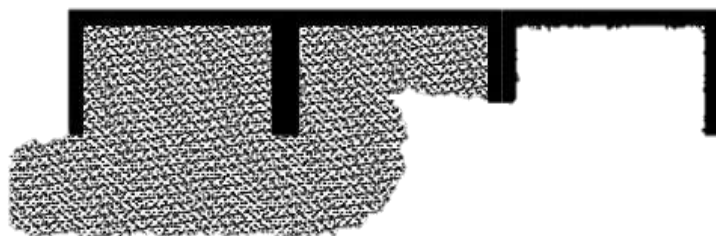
Panneau pour Revêtement des accès aux plages type -GC 85- ou GC 65
